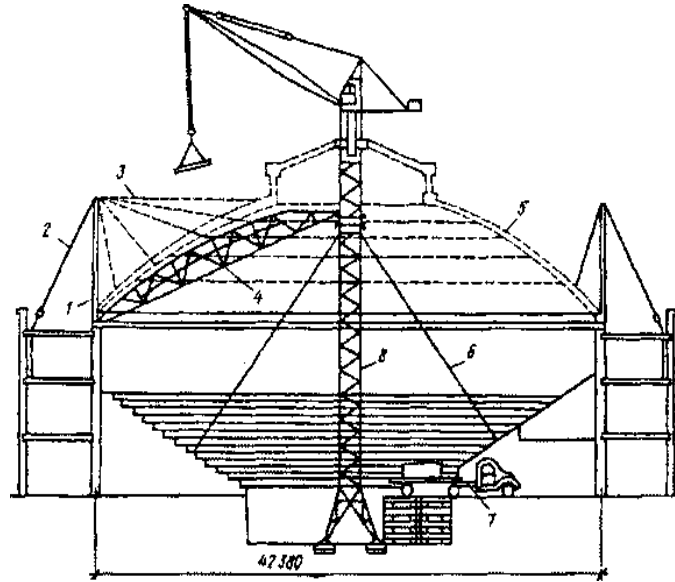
Приклад схеми монтажу купольної споруди за допомогою пересувної ферми-шаблону:
